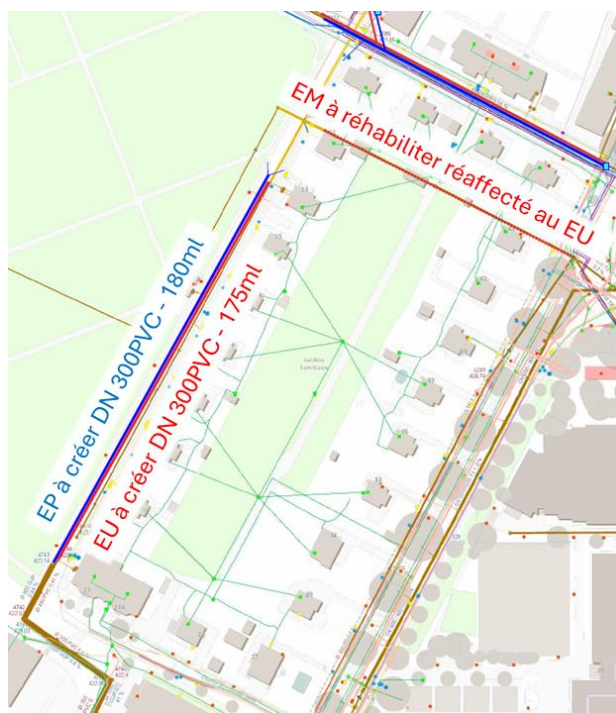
Extrait de plan - projet d'assainissement Coin-de-Terre Sud
